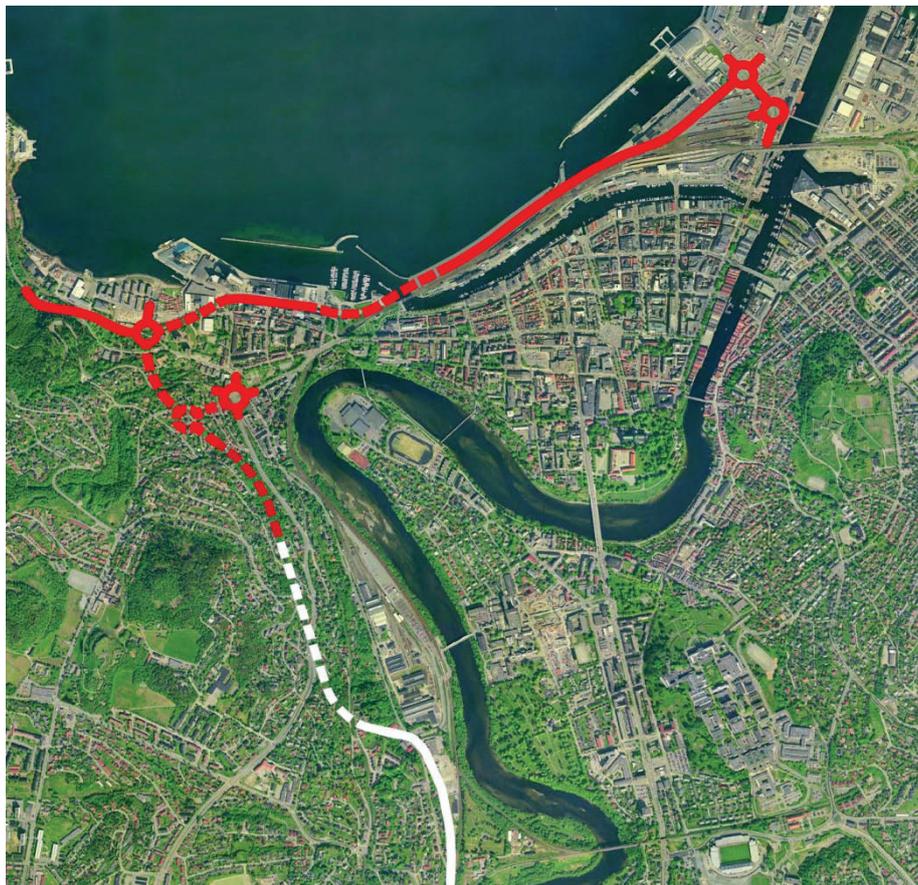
Rote Markierung → E6 North Relief Road Project [1]
